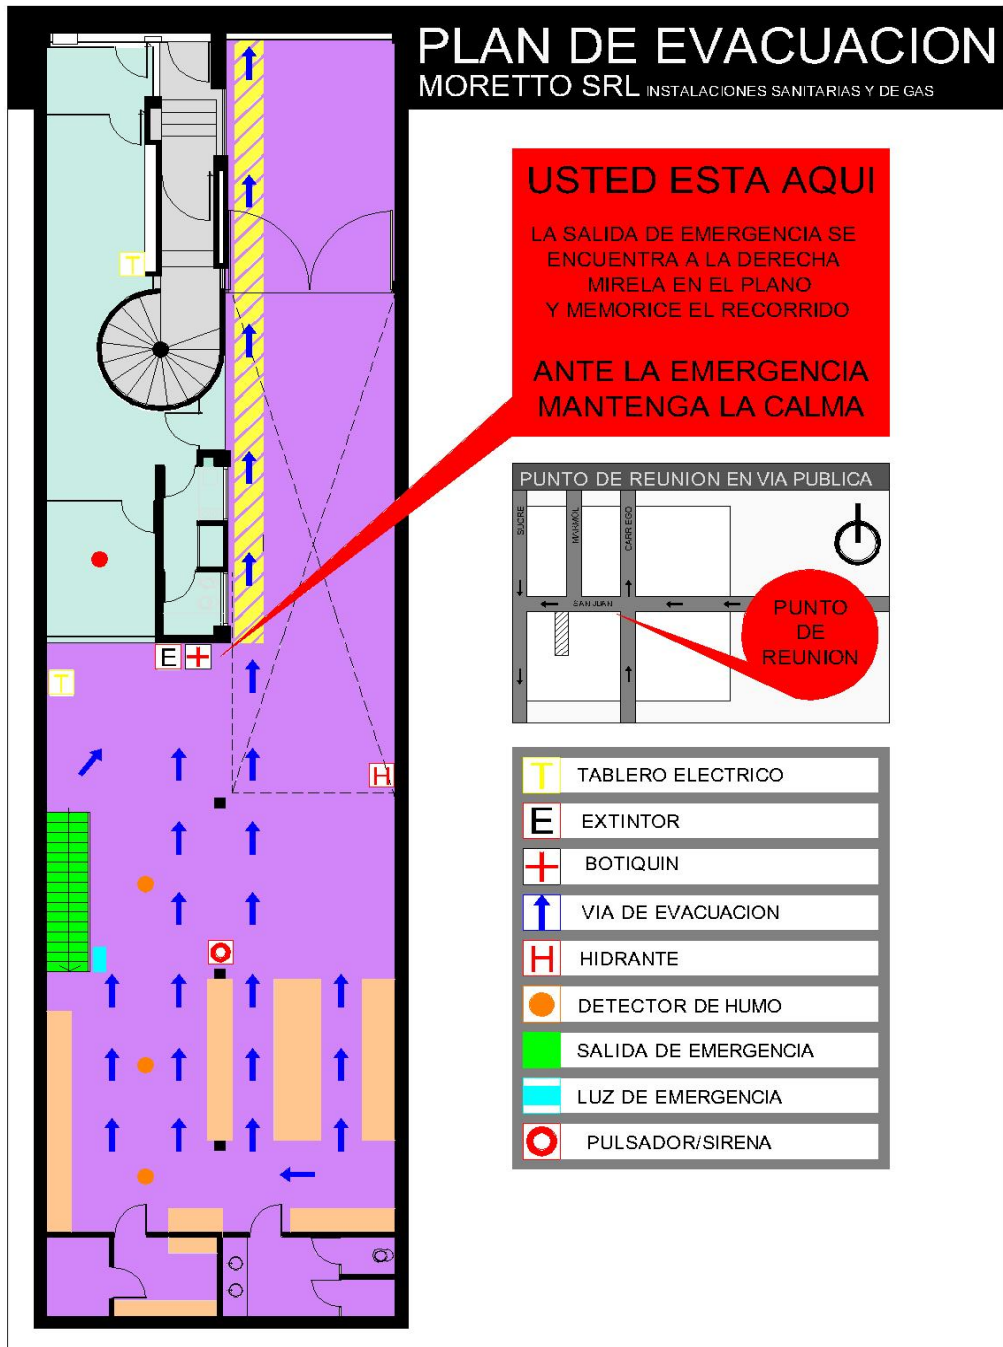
Plano de Evacuación Planta Baja. Elaboración Propia.
